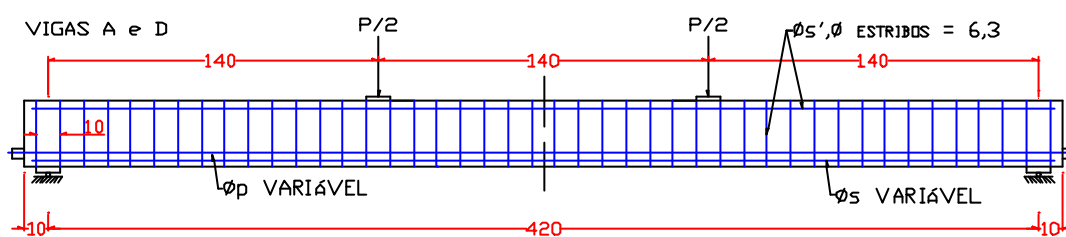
Detalhamento das vigas A e D (cotas em cm)
